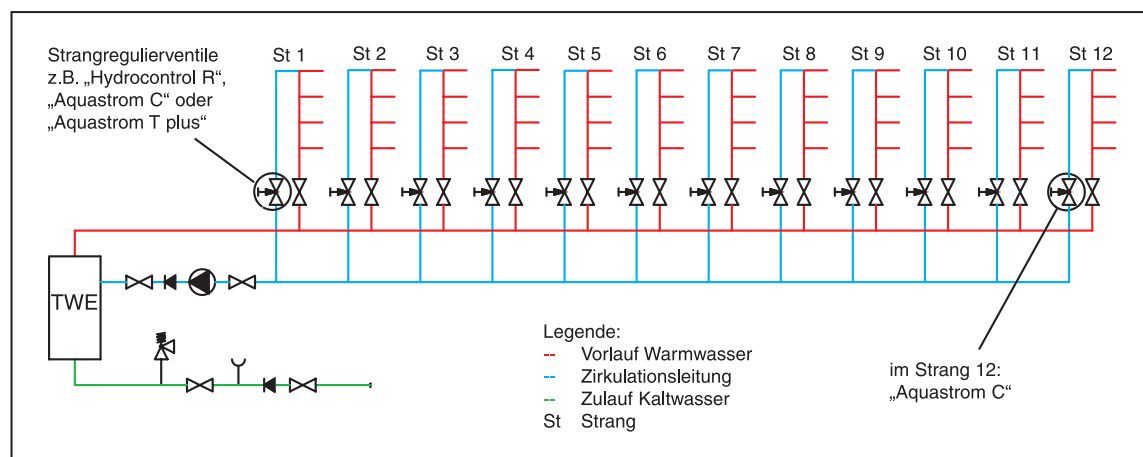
12-Strang Trinkwasseranlage mit Warmwasser-Zirkulation.
